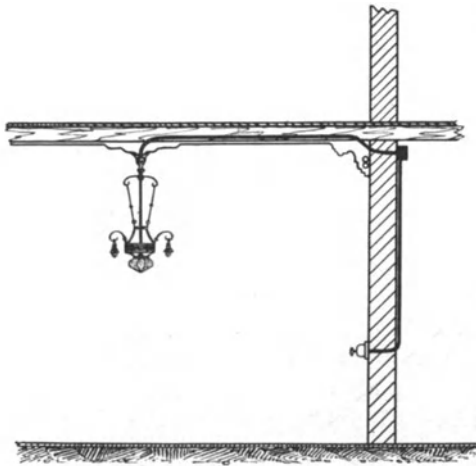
Schnitt durch ein Zimmer mit nachträglich verdeckt verlegten Rohrleitungen.
